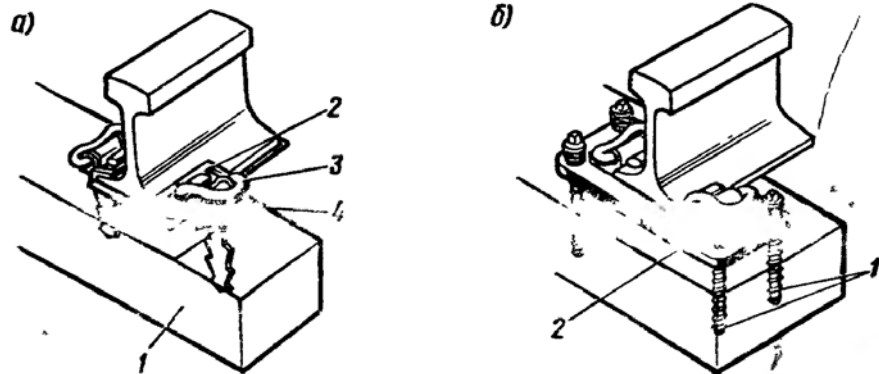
Безболтовые крепления типа Пендрол для железобетонных шпал
